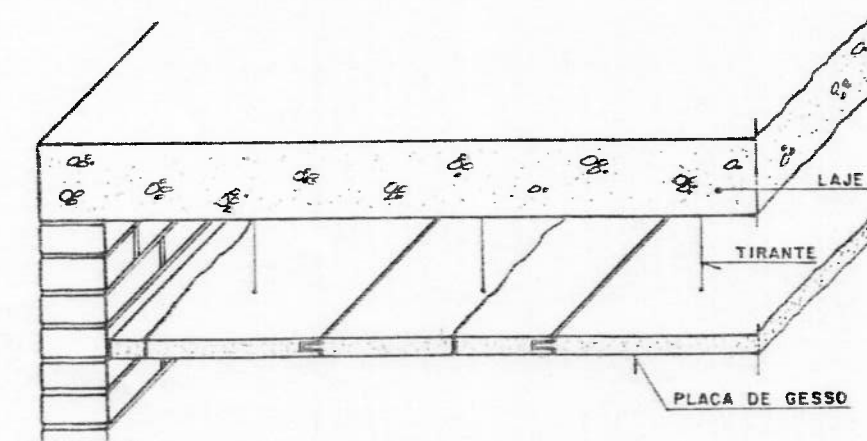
Fissuração de placas de gesso, em forro rigidamente encunhado nas paredes
